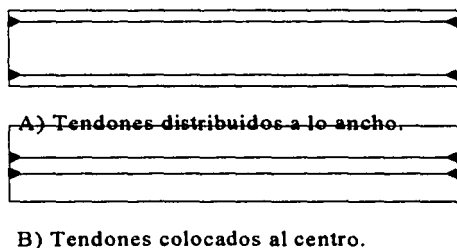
Formas de instalación horizontal de cable de presfuerzo dentro de un elemento.
